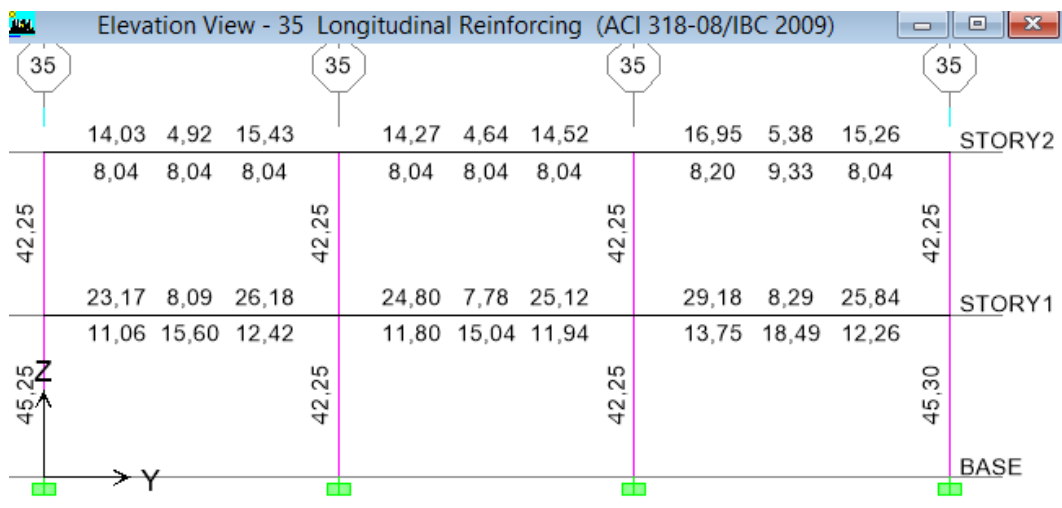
Acero en Vigas y Columnas en el Pórtico 35 – C. Quirúrgico- (NEC-11)
